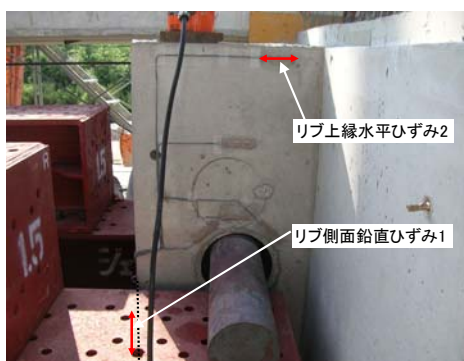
吊上げ用突起リブのひび割れ
